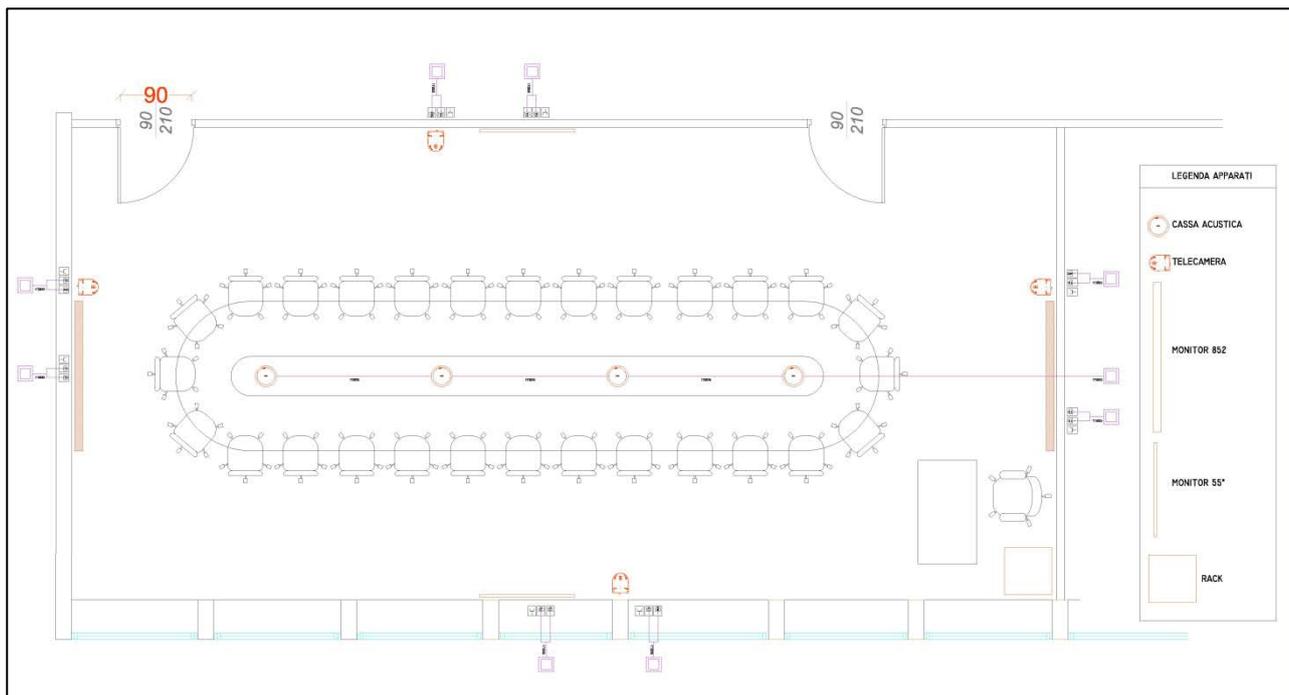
Sala Riunioni di Direzione - Canalizzazioni predisposte e disposizione Apparatì Soffitto/Parete
